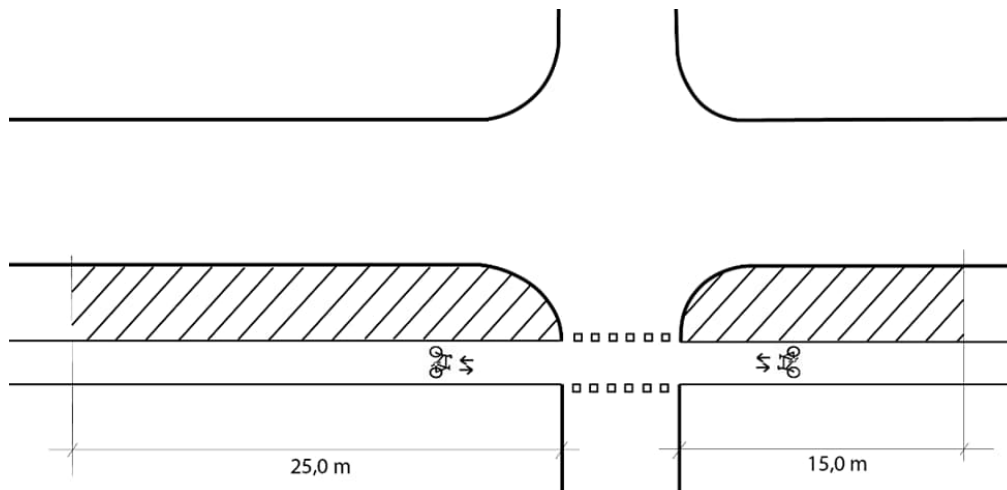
Cykelpassage minst 6,0 m från parallell körbanekant
